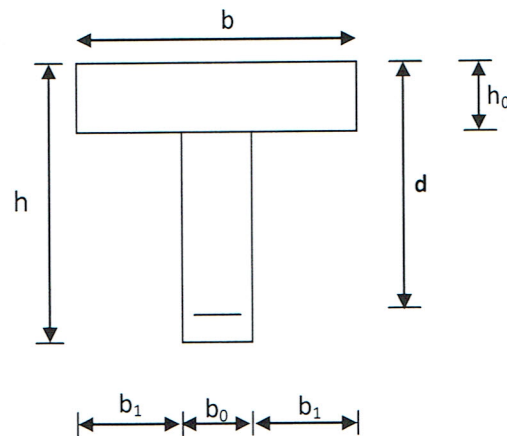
Section de calcul de la poutrelle après coulage de la dalle de
